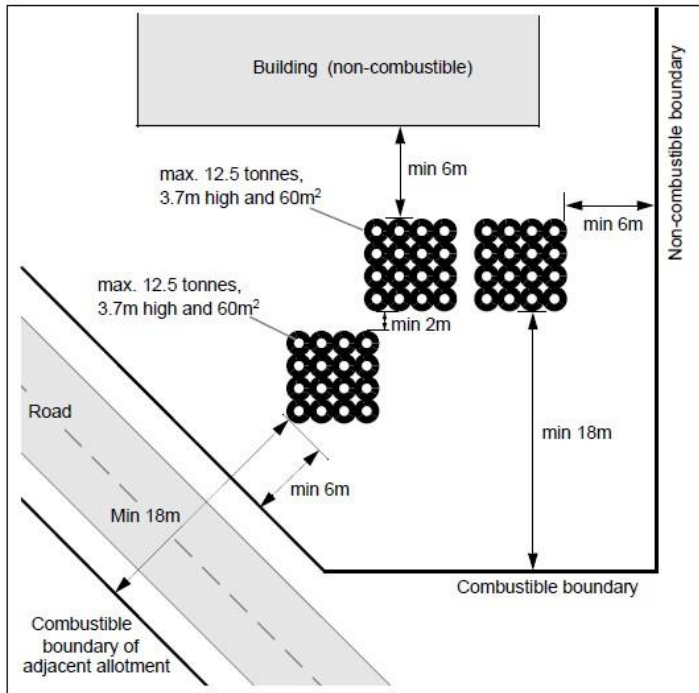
Minimalabstände bei kleinen Lagerflächen [23]
